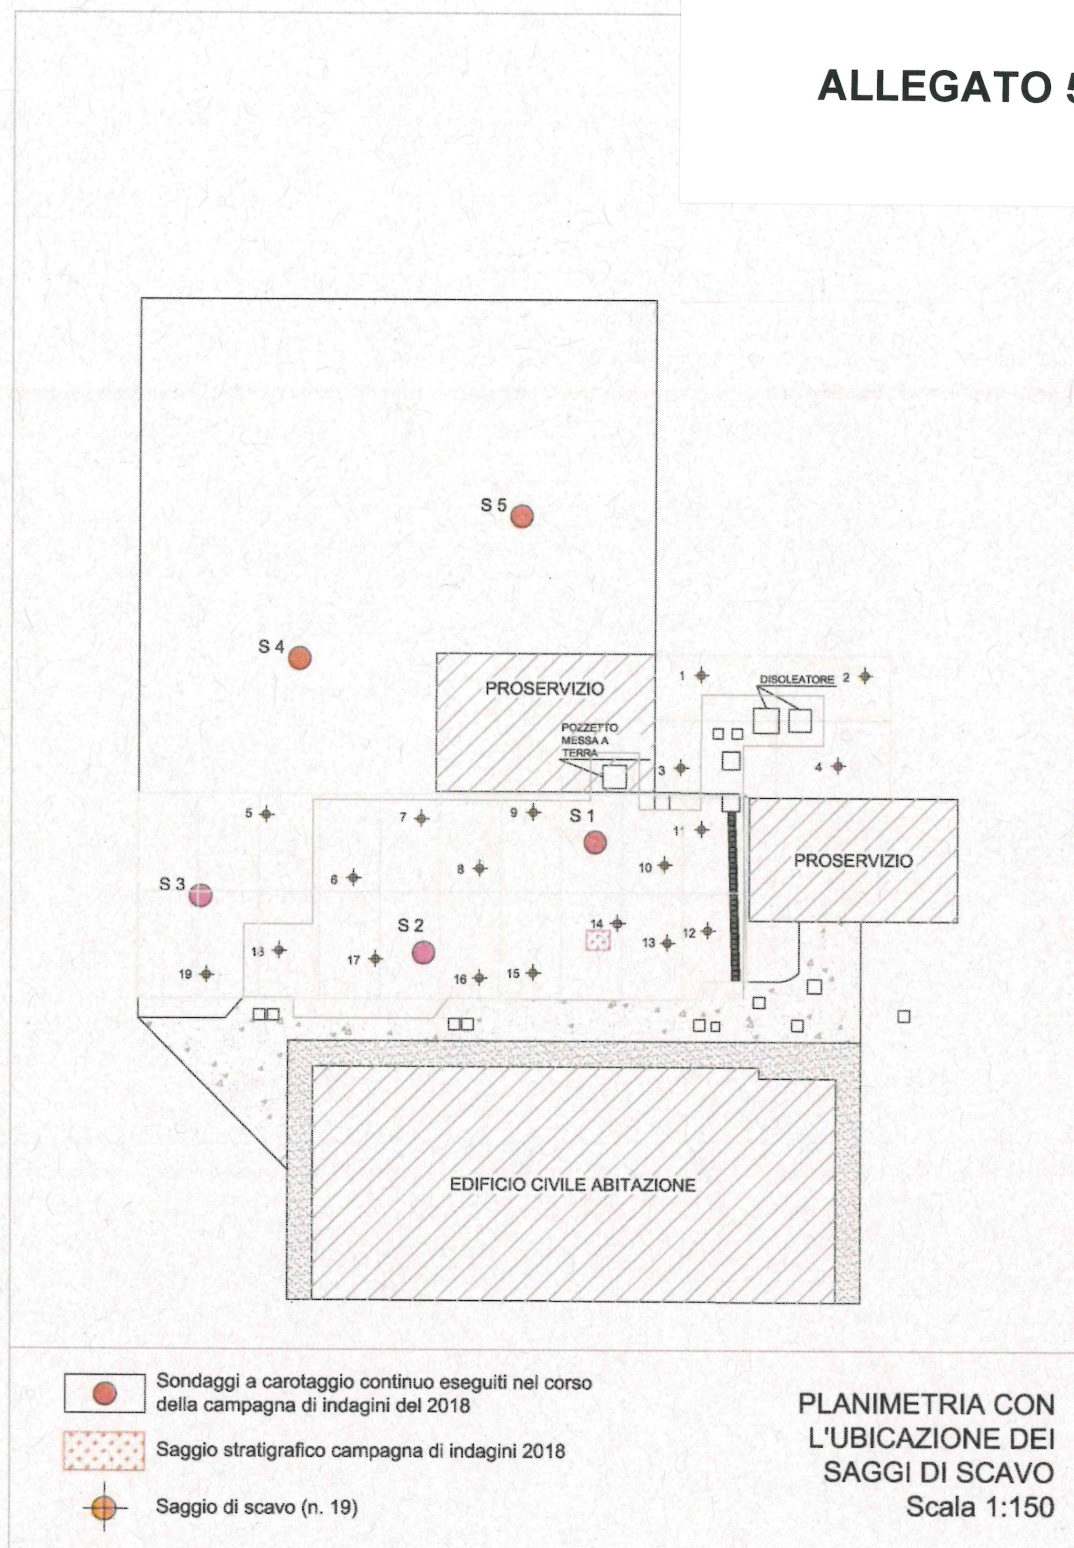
Planimetria dell'area con ubicazione dei saggi di scavo
